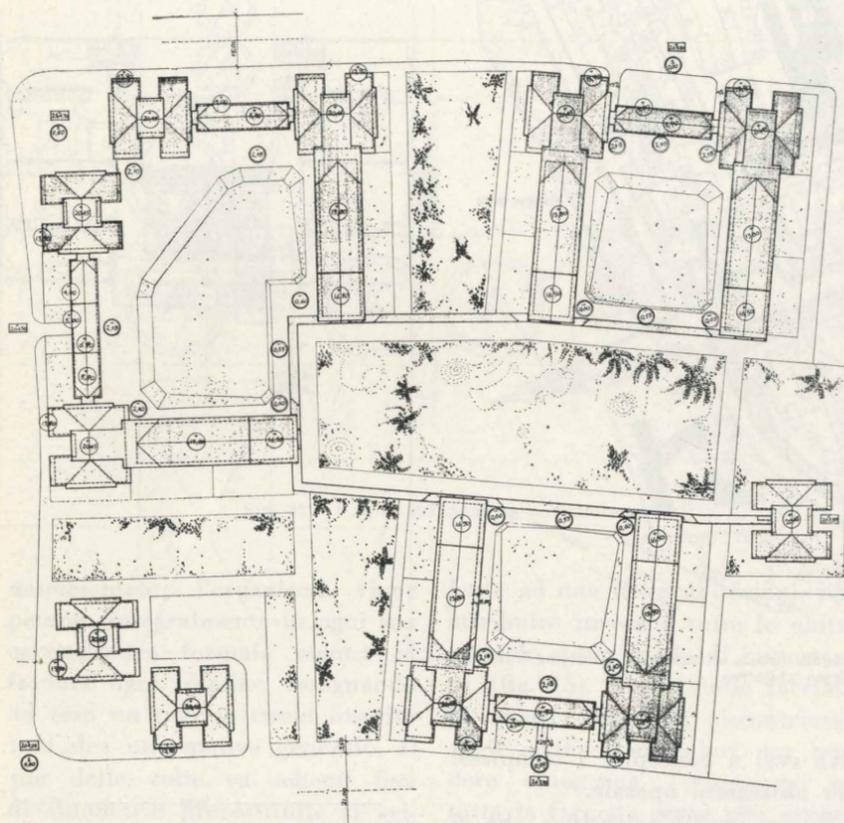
Zona G alle Vallette (Capogruppo A. Cavallari-Murat). Planimetria generale.
